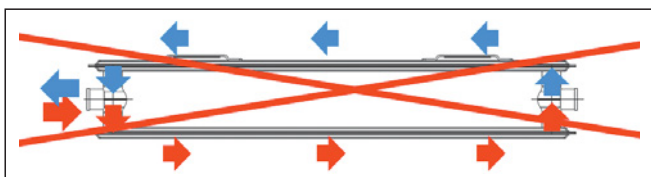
Radiátor se sériovým zatékáním, zadní deska zezadu
